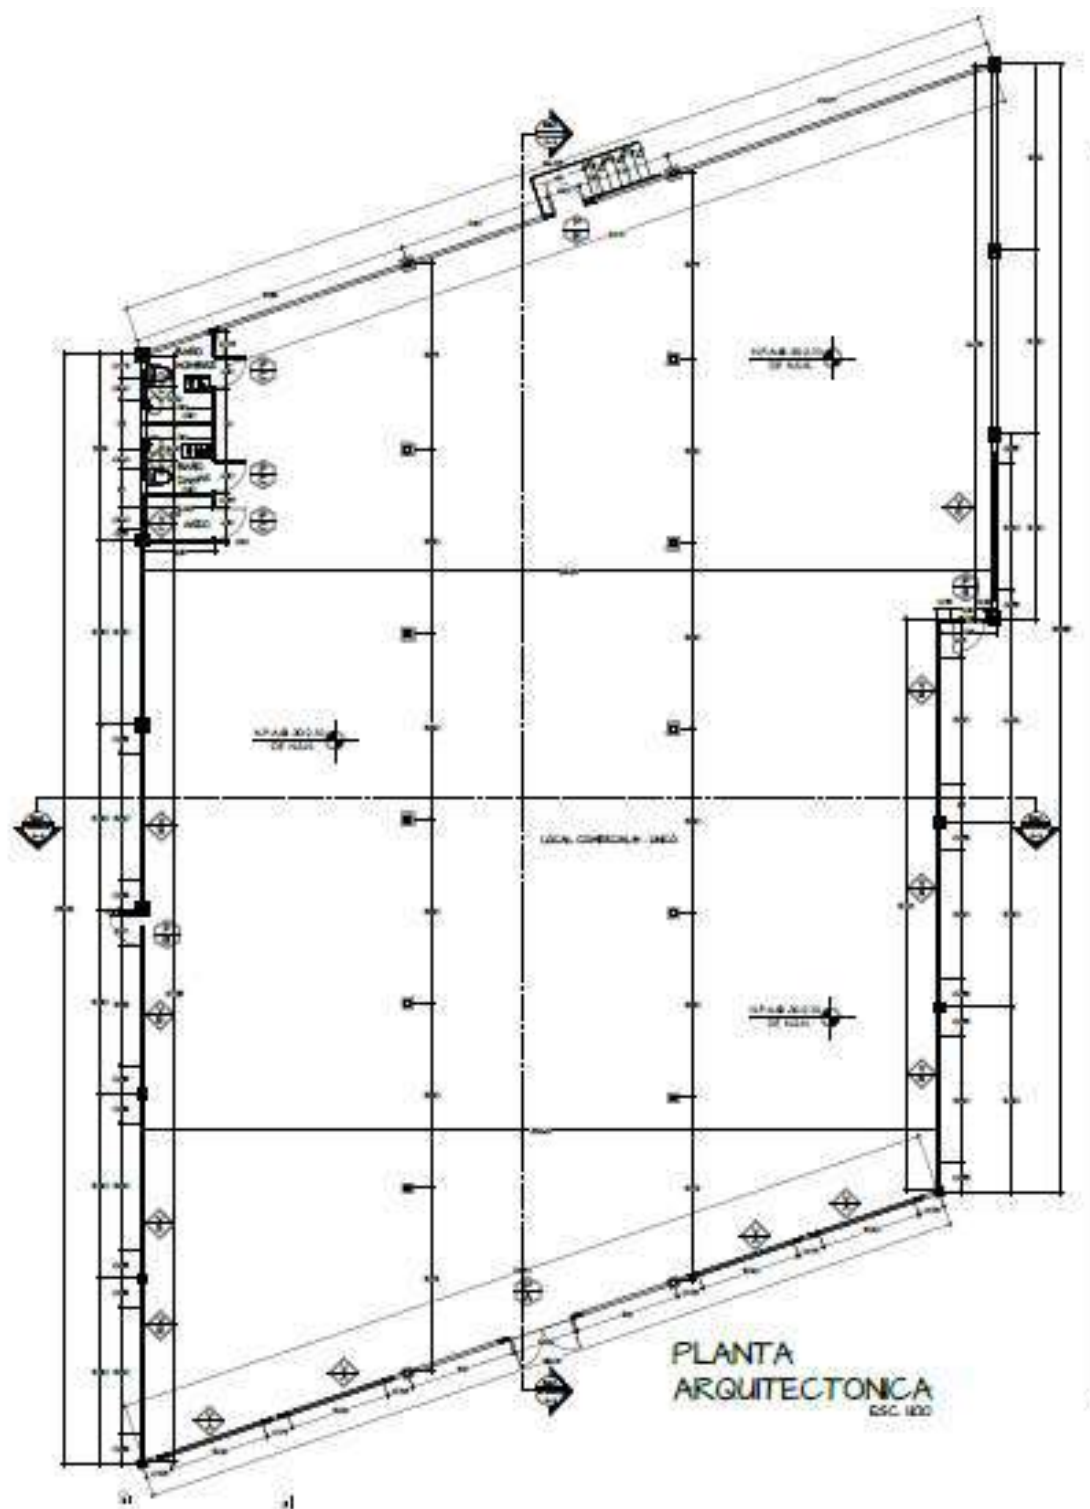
Planta arquitectónica del proyecto. Fuente. Plano del proyecto
